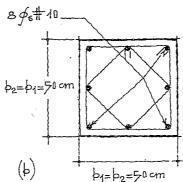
Sección trons versal de la columna vista en planta, (b).
